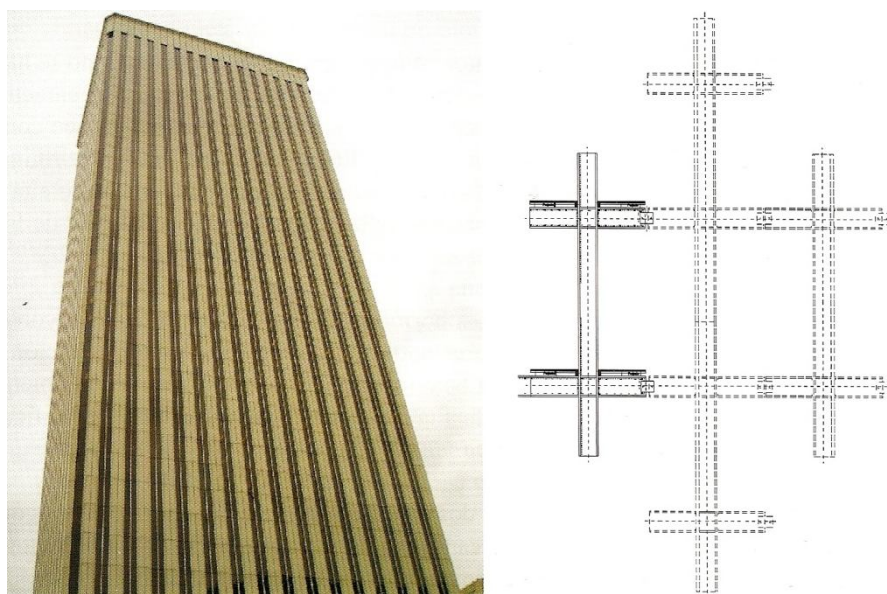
Torre Picasso (Madrid). Alçado e detalhe de pilares pré-fabricados (Hermoso, 2005)
